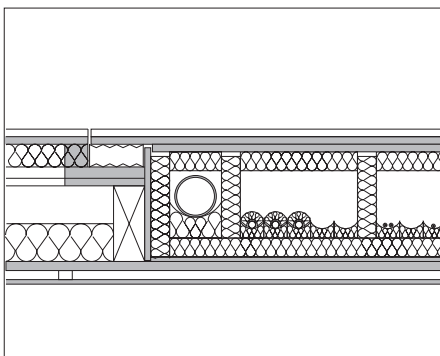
Systemschnitt horizontale Trasse mit Boden- und Deckenaufbau; Einbau einer Brandschutzbekleidung (Auslaibung) über die gesamte Höhe der Aussparung
